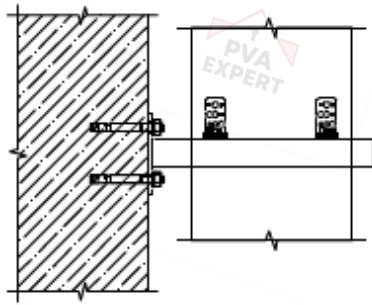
Узел крепления вертикального прямоугольного воздуховода к стене
